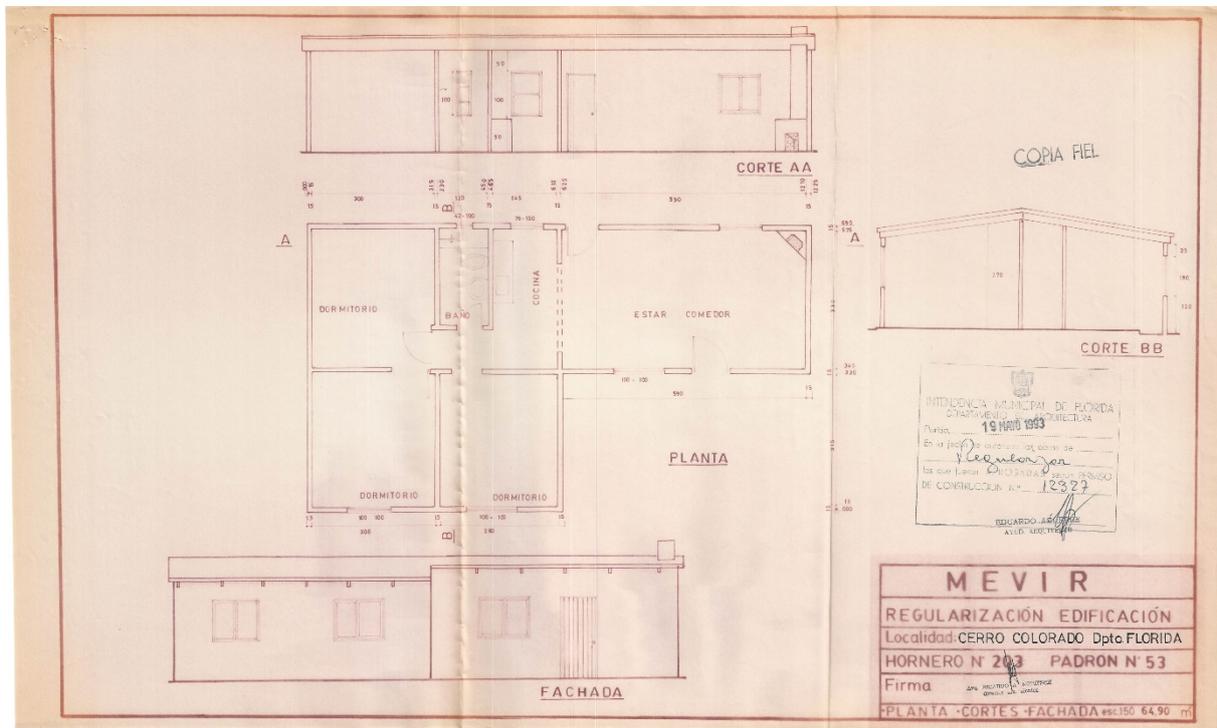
Planta tipo de 3 dormitorios utilizada en Cerro Colorado. Archivo Mevir.
